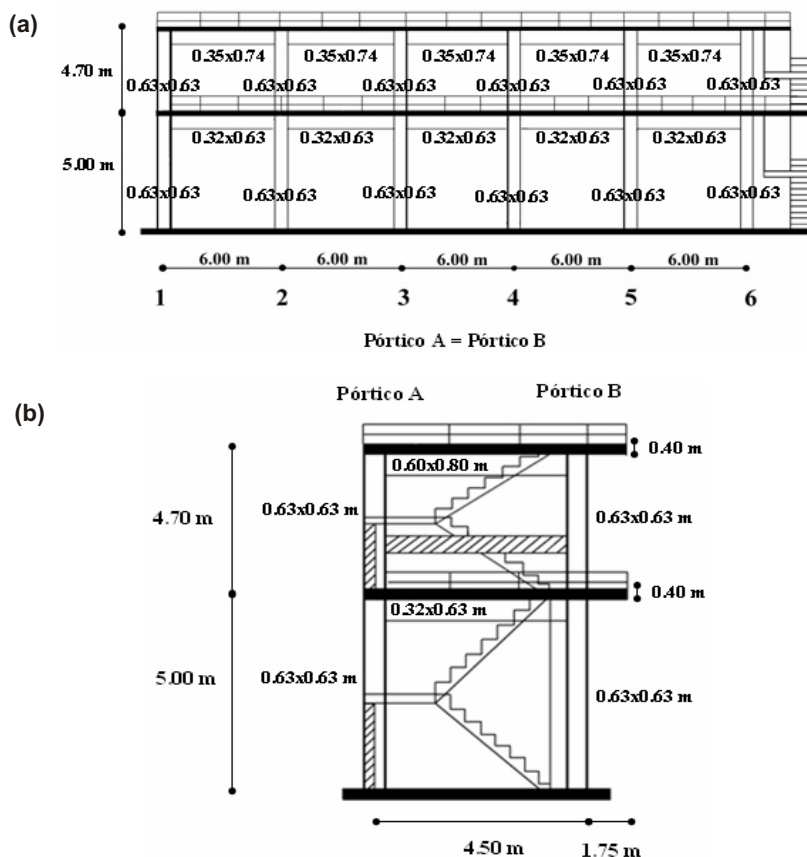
Esquema de la planta de vapor. (a) Vista lateral. (b) Vista frontal.
